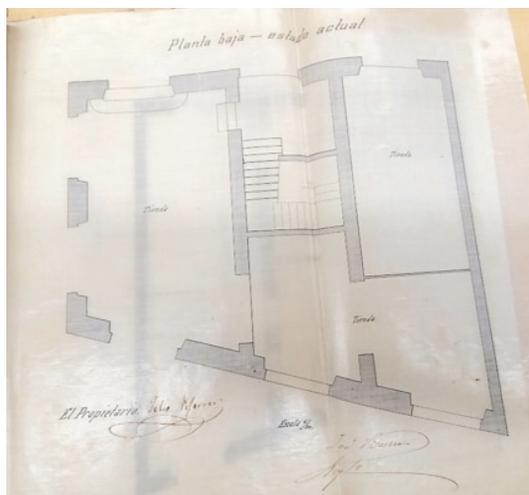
Josep Vilaseca, Planta baixa de la casa de Felio Piferrer abans de la reforma, AMCB, 1883
